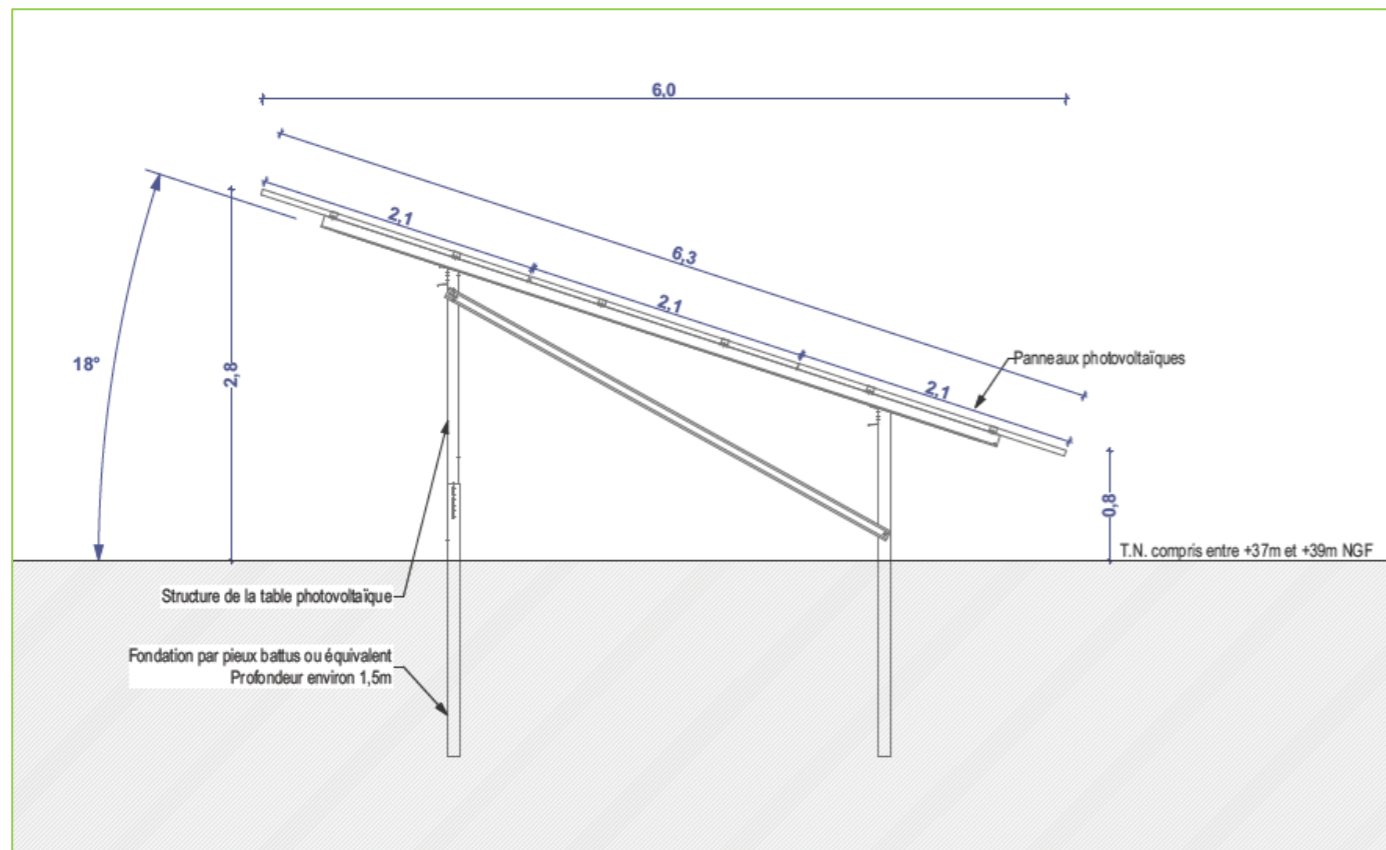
Vue de la façade « ouest » des tables (source : ADEN)
